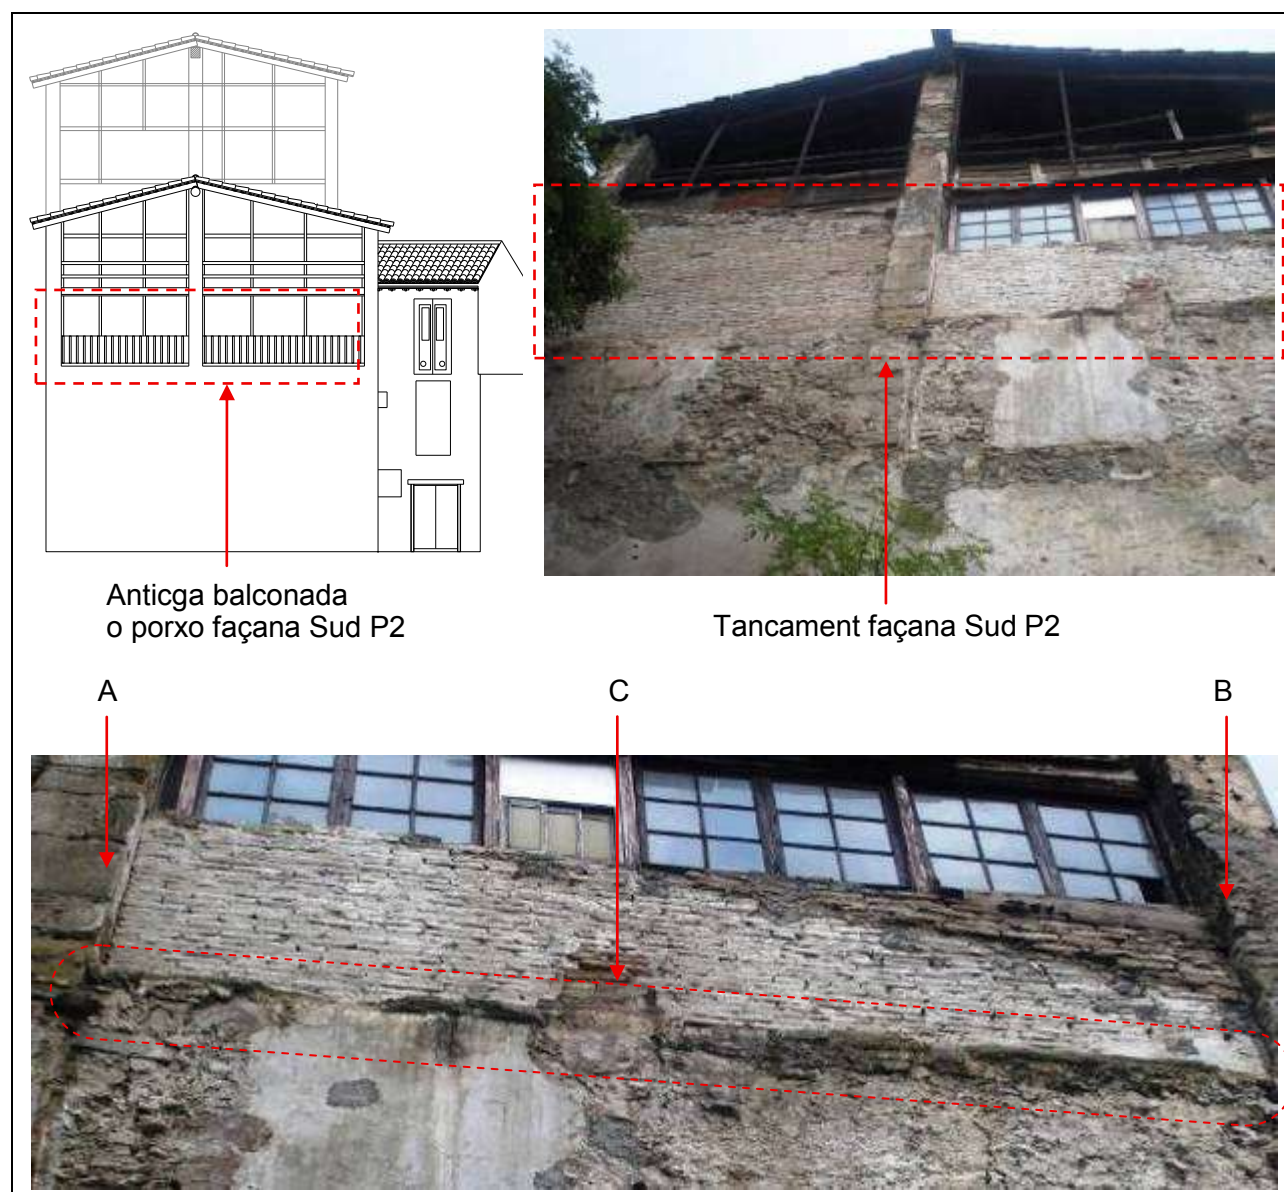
Tram de façana planta segona. Es veu la paret de maó i artesanal i finestres, retirada cap a l'interior de la planta i el detall dels escopidors d'aigua al forjat P3.
